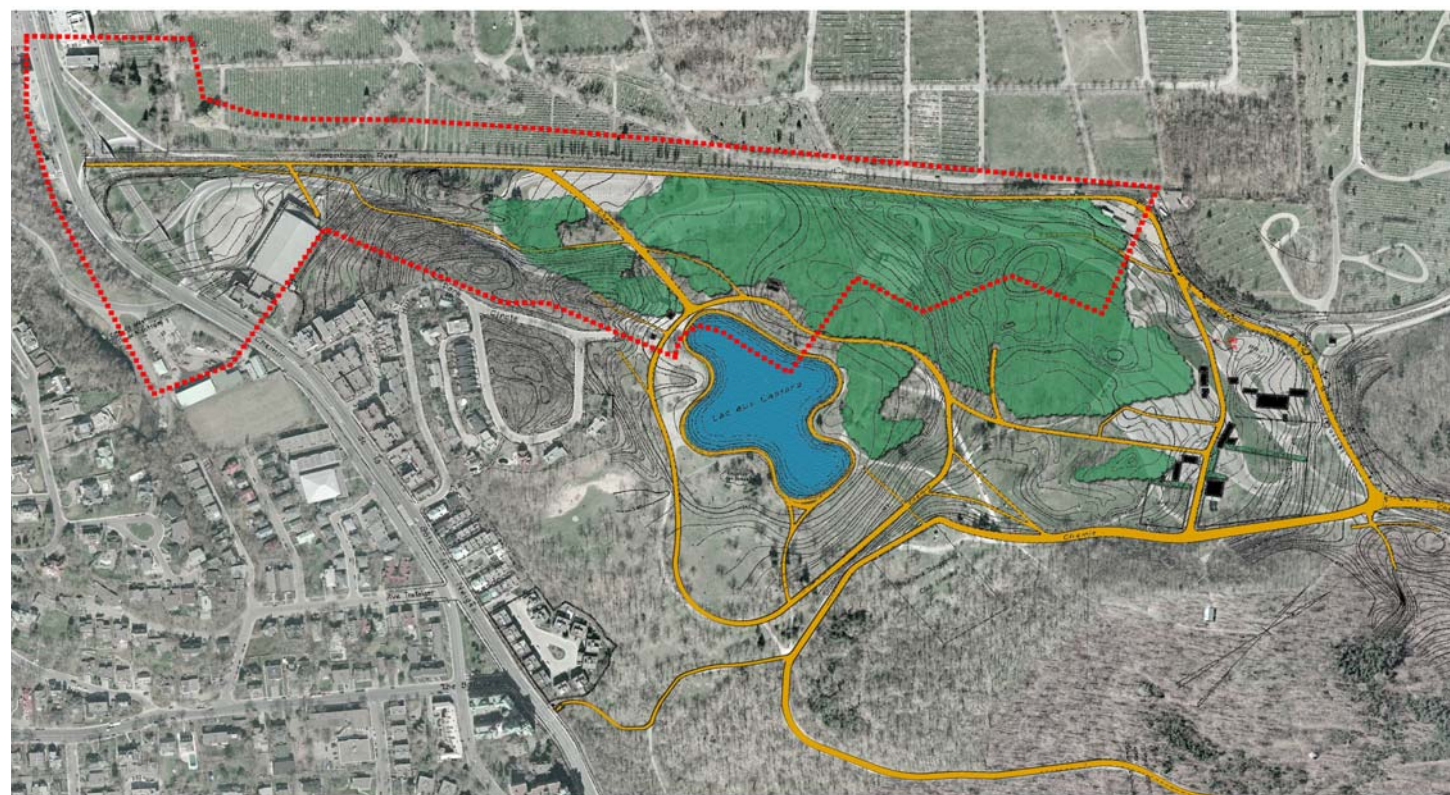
Superposition au plan actuel du plan de l'accès au tramway, 1947
